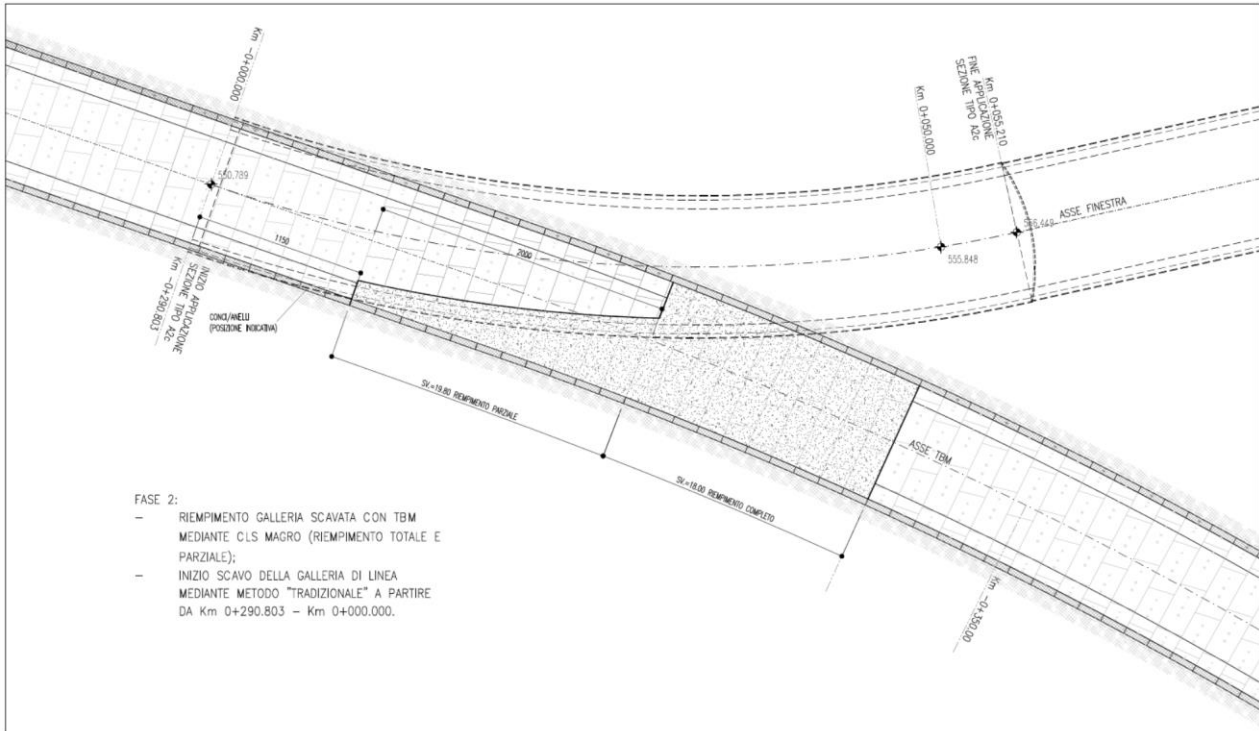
Biforcazione finestra tradizionale e TBM - Fase 2
